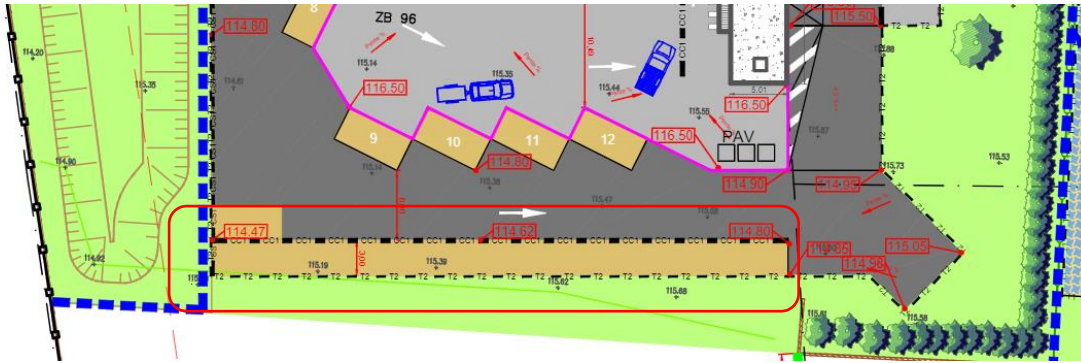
Extrait du plan de la déchèterie d'Avesnes le Comte – focus sur les dalles béton de dépose des bennes
